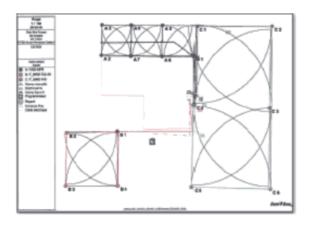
Exemple d'un plan d'irrigation, en traçant l'amplitude parvenue par les arroseurs
